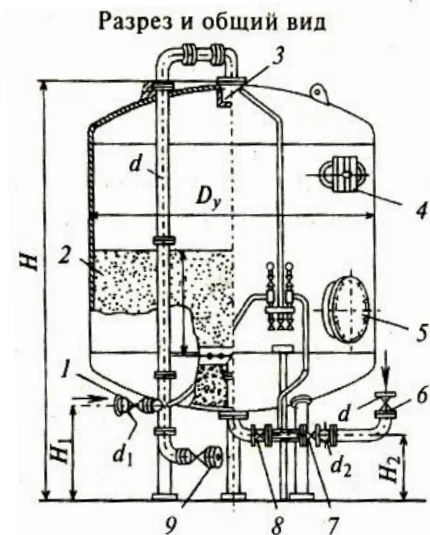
Напорный вертикальный фильтр с зернистой загрузкой: 1 – подача воды на очистку; 2 – фильтрующий слой из зернистой загрузки; 3 – верхнее распределительное устройство; 4 – контрольный эллиптический лаз; 5 – круглый лаз; 6 – подвод промывной
